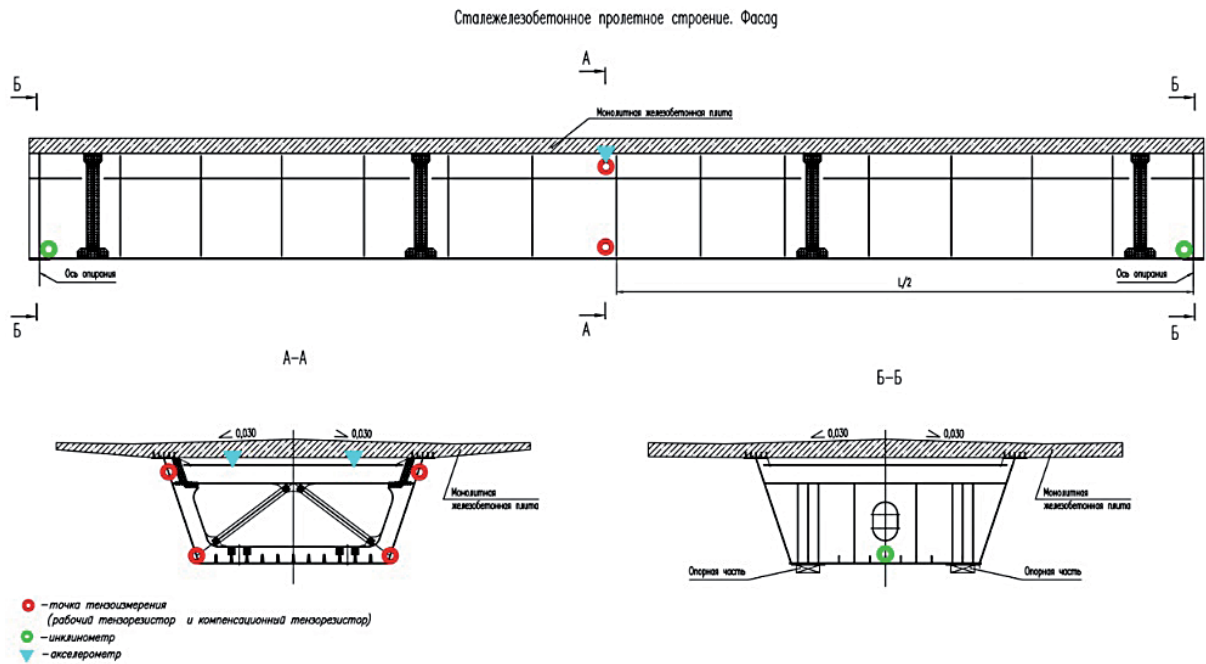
Расстановка датчиков на сталежелезобетонном пролетном строении
